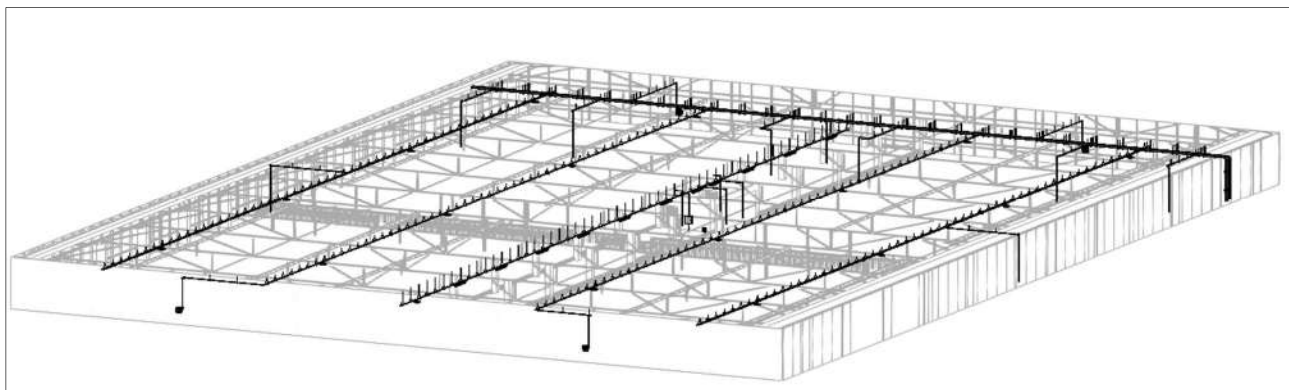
Croqui infraestrutura geral presente na cobertura do Prédio 02.
